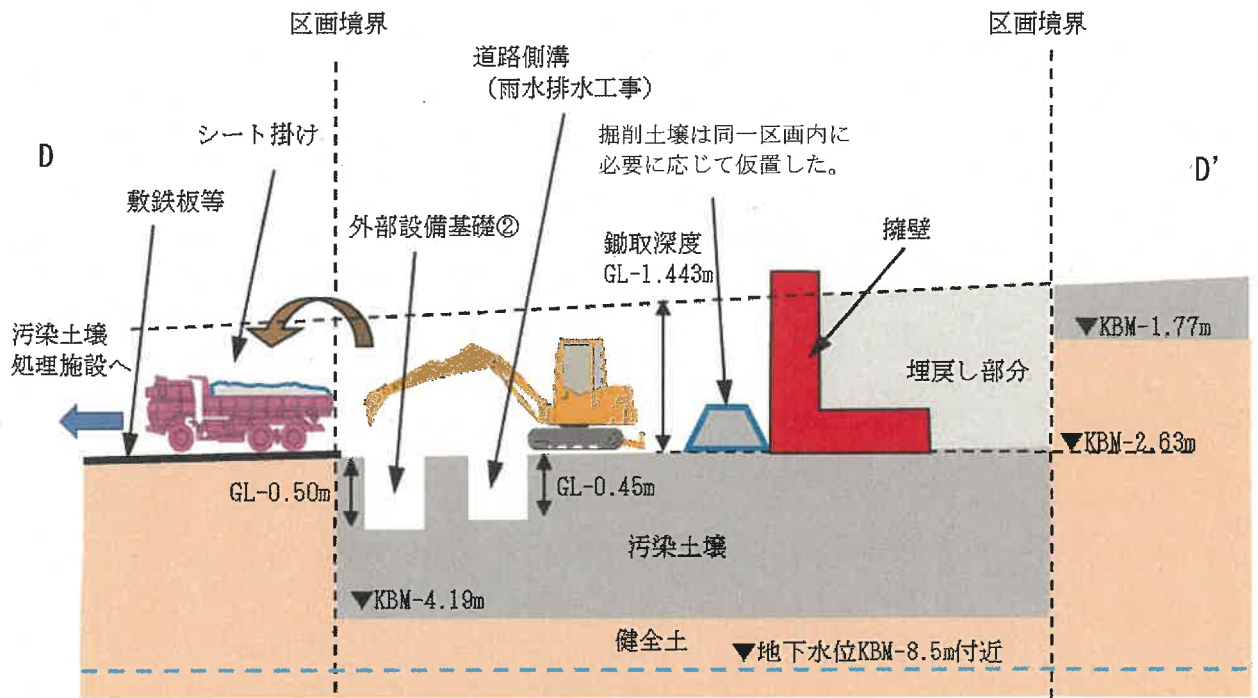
(1) 土地の形質の変更の施工方法を明らかにした断面図 (雨水排水工事, 路盤鋤取り, アスファルト舗装工事) D-D' 断面
